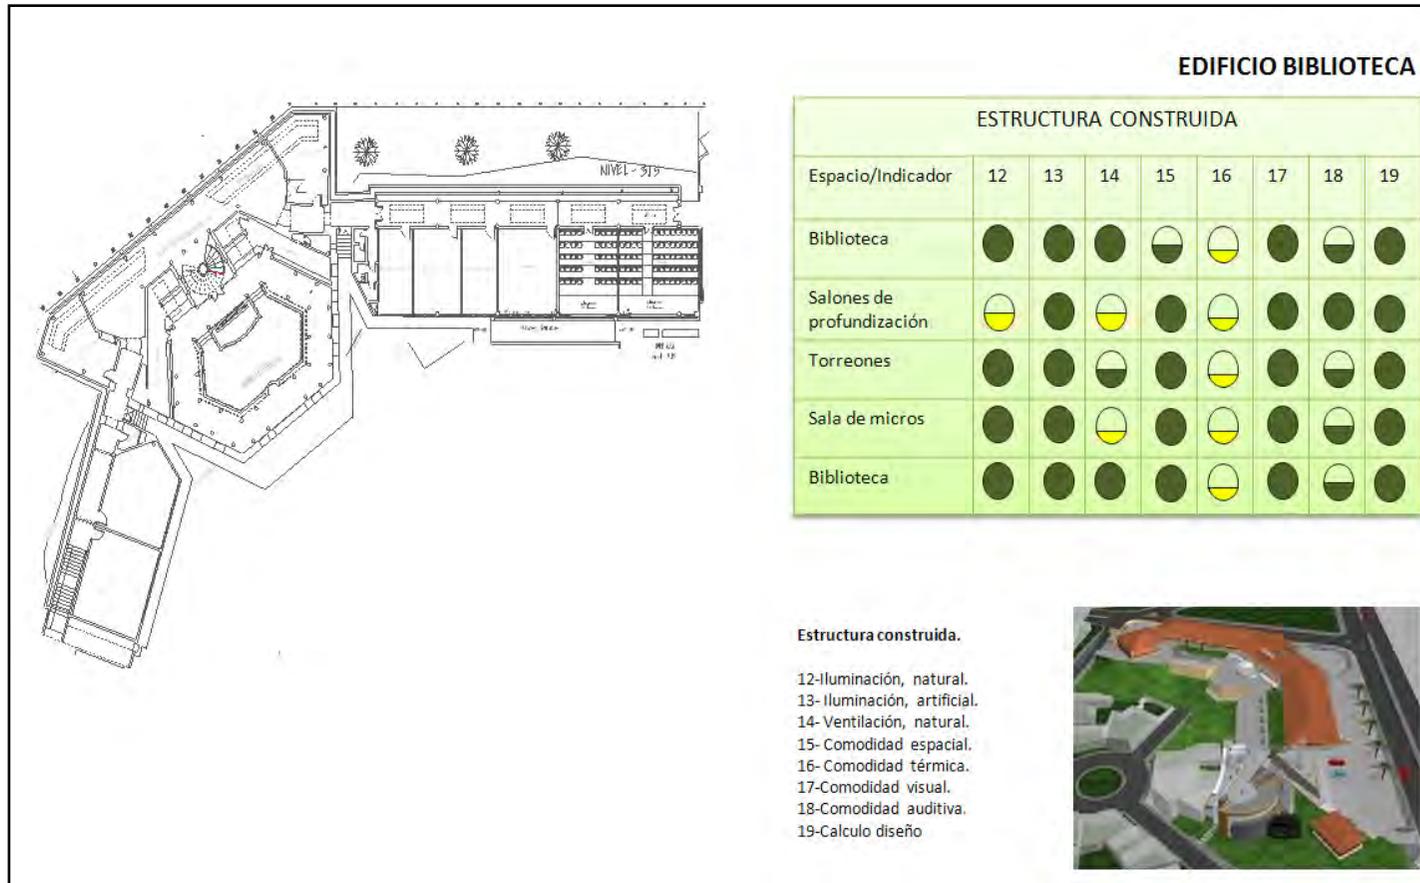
Espacialización de indicadores estructura construida edificio Biblioteca Germán Arciniegas. Elaboro Germán Villada Sánchez
